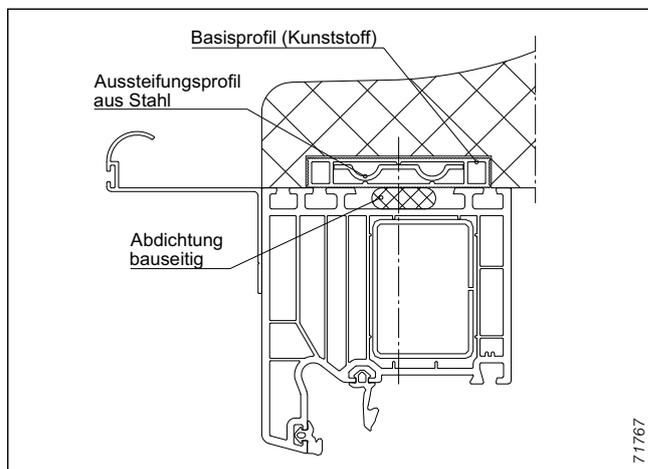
Fensteranbindung über Kunststoffprofil mit Aussteifungsprofil Stahl
